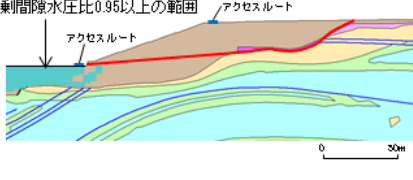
解析モデル図 (⑧-⑧' 断面)
